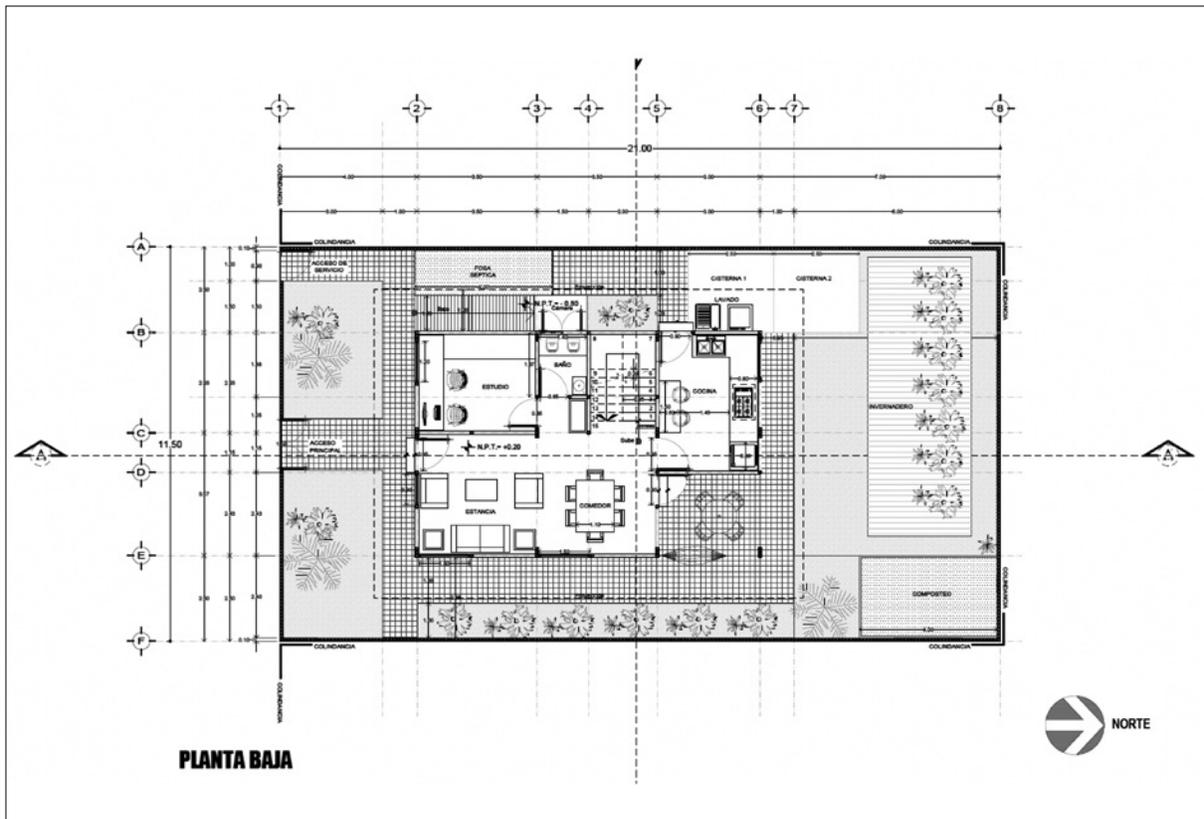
Planta baja de las viviendas de aproximadamente 58 m² de construcción. Diseño: A. Cedeño y K. Aquino, 2020.
